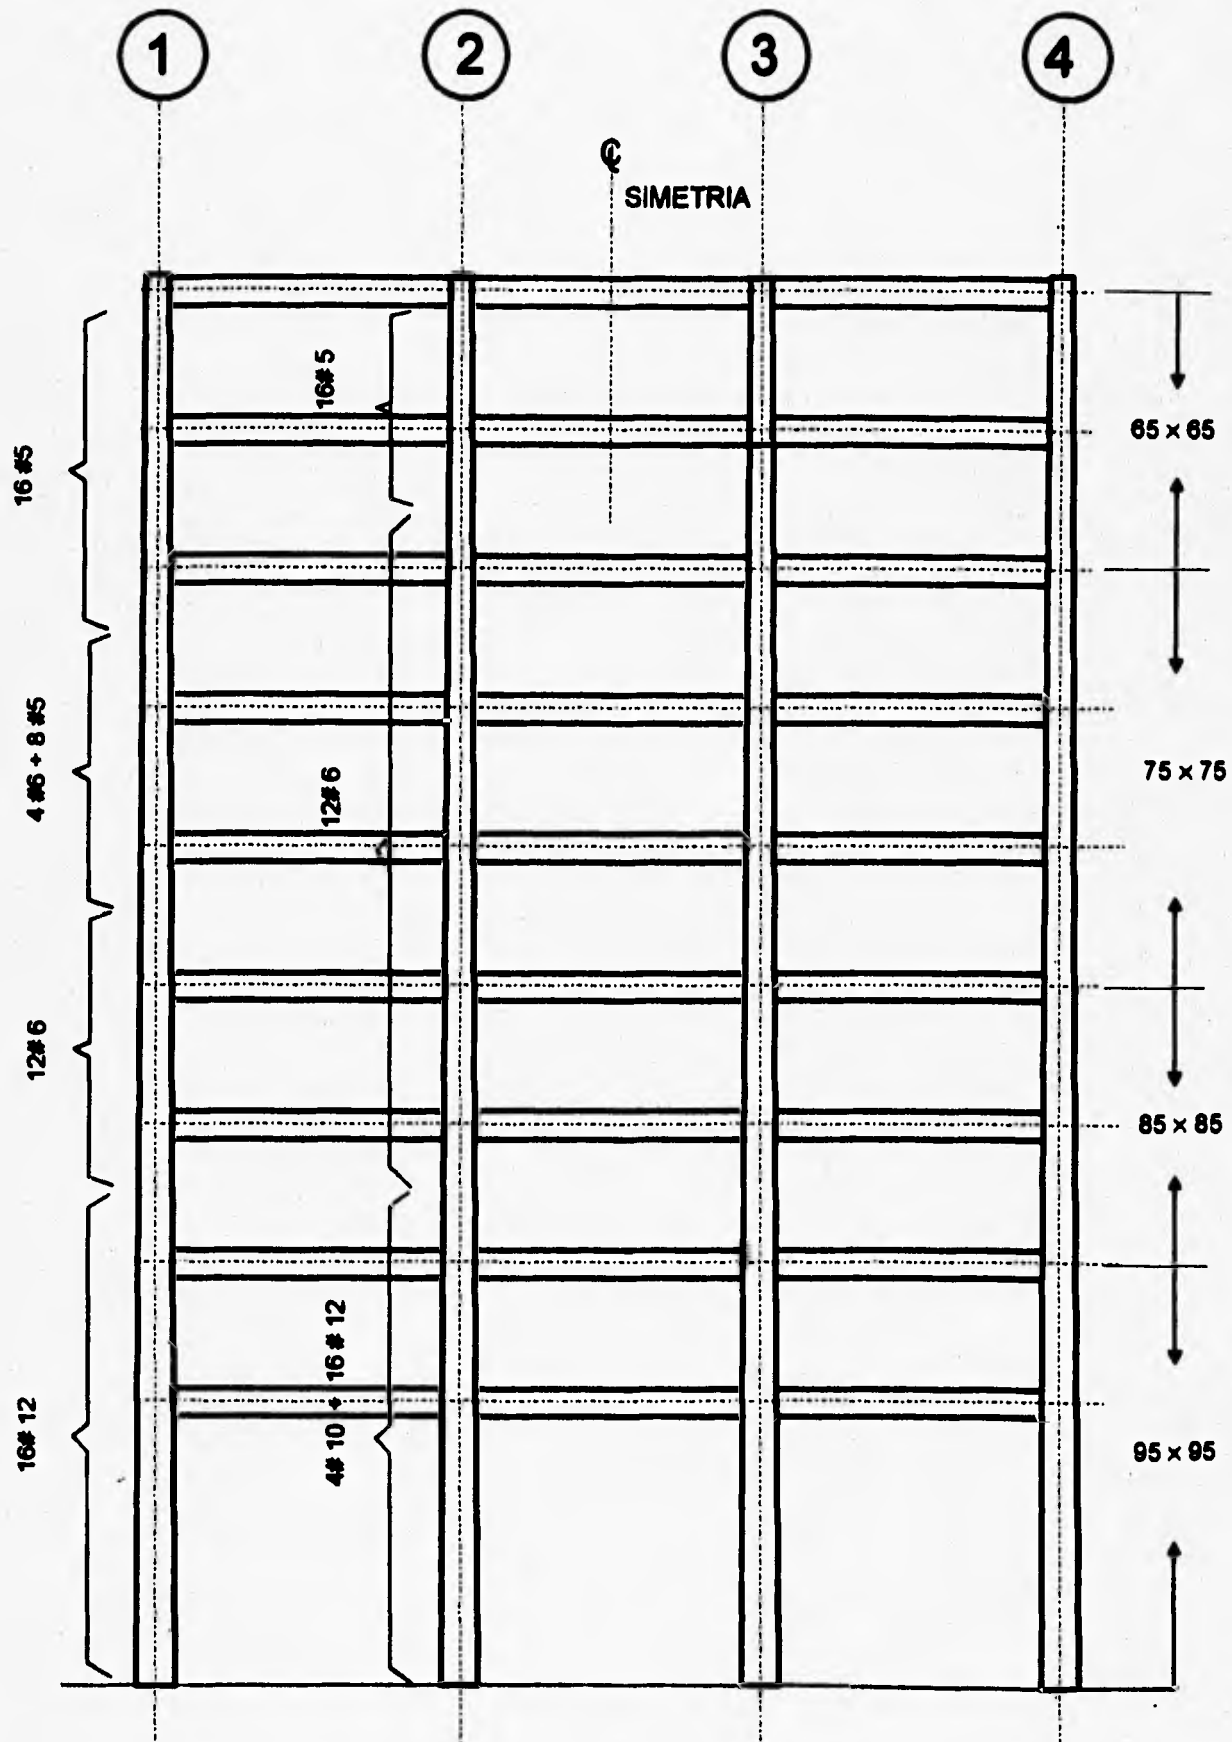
Distribución del Refuerzo Longitudinal en Columnas
